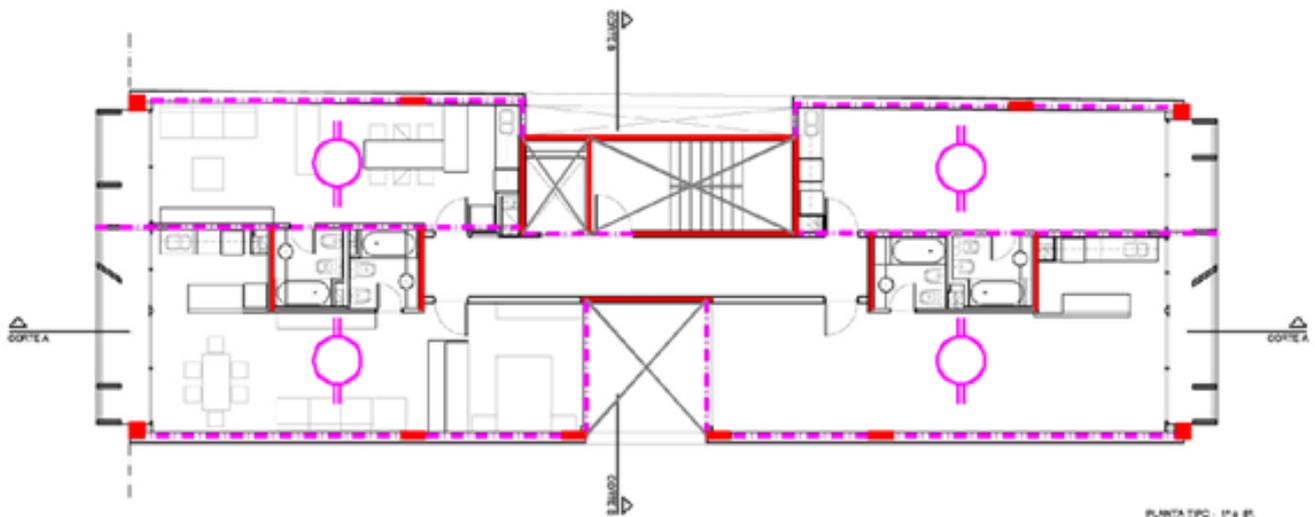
Esquema estructural de planta tipo. Fuente: Elaboración propia
